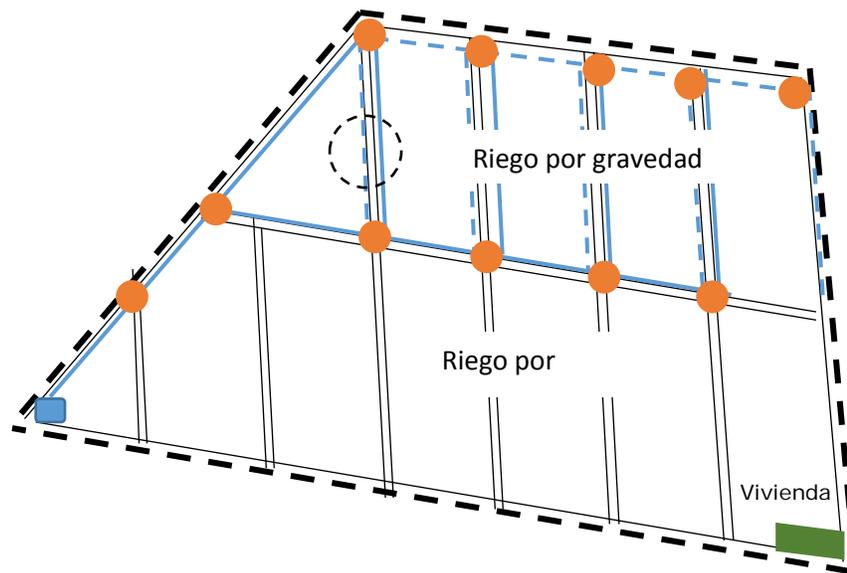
Vista en planta del circuito vial e hidráulico. Círculos naranja corresponden a puentes o sifones. Círculo punteado es la vista en corte de la Figura 18. Sector verde corresponde a vivienda e instalaciones
